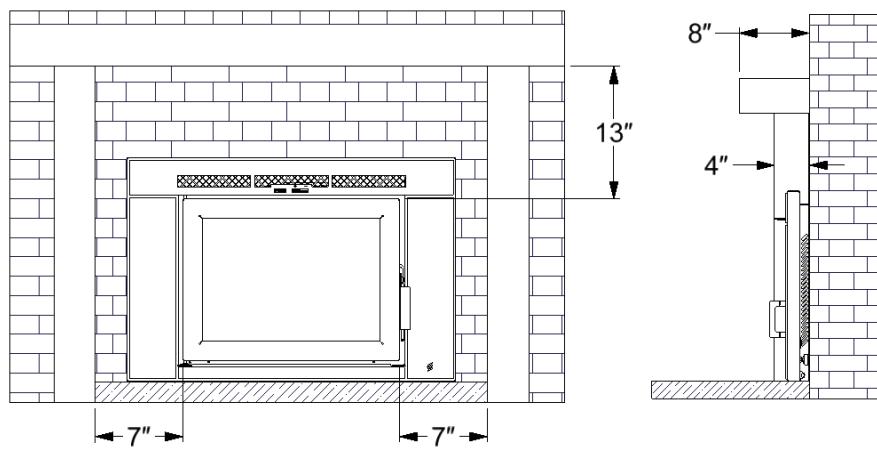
Dégagements aux combustibles (a) Vue de face (b) Vue de côté
